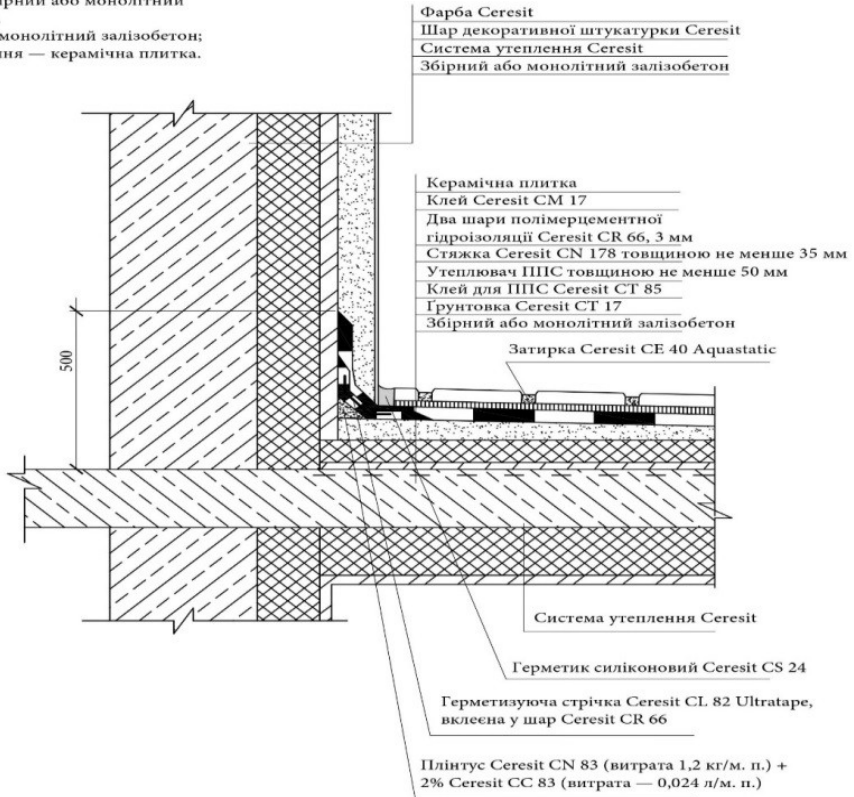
Конструкція гідроізоляції балконів з зовнішнім утепленням.
